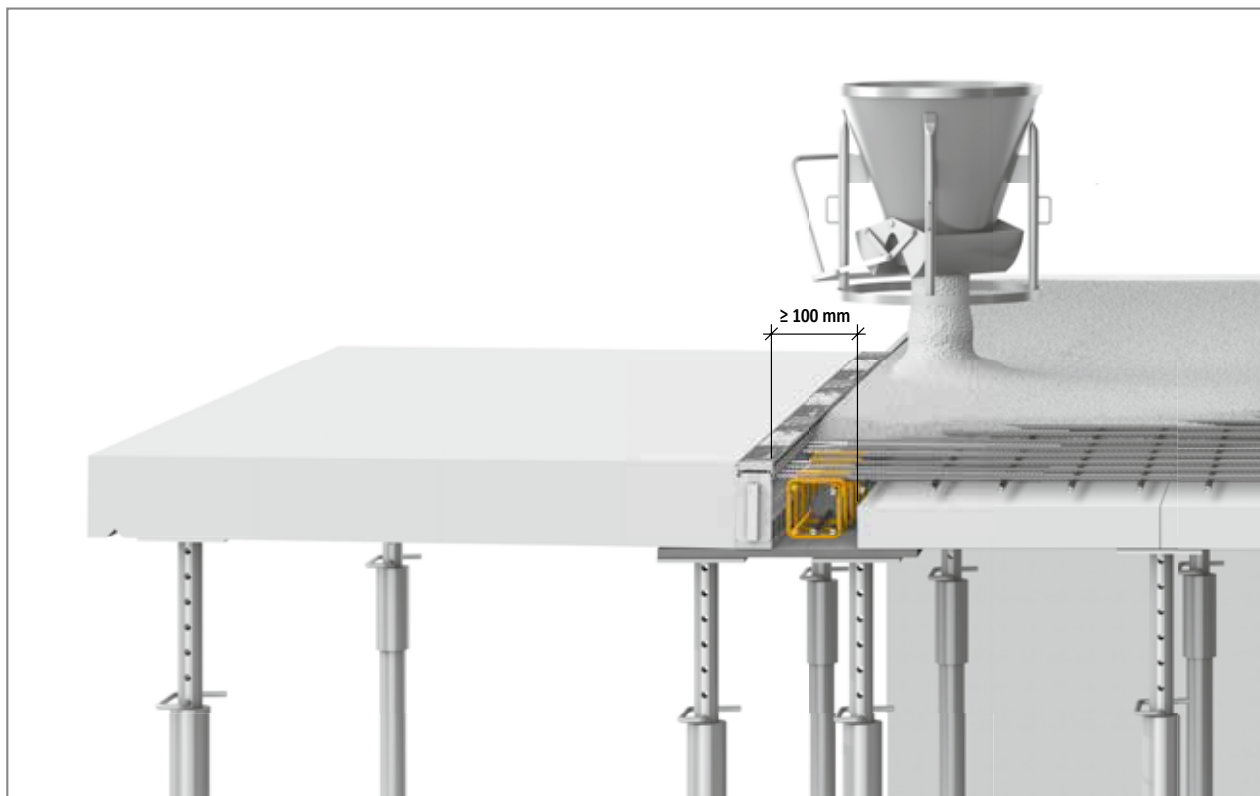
Schöck Isokorb® T tipo KL: riempimento delle strisce di aderenza con calcestruzzo gettato in opera (giunto di compressione)
